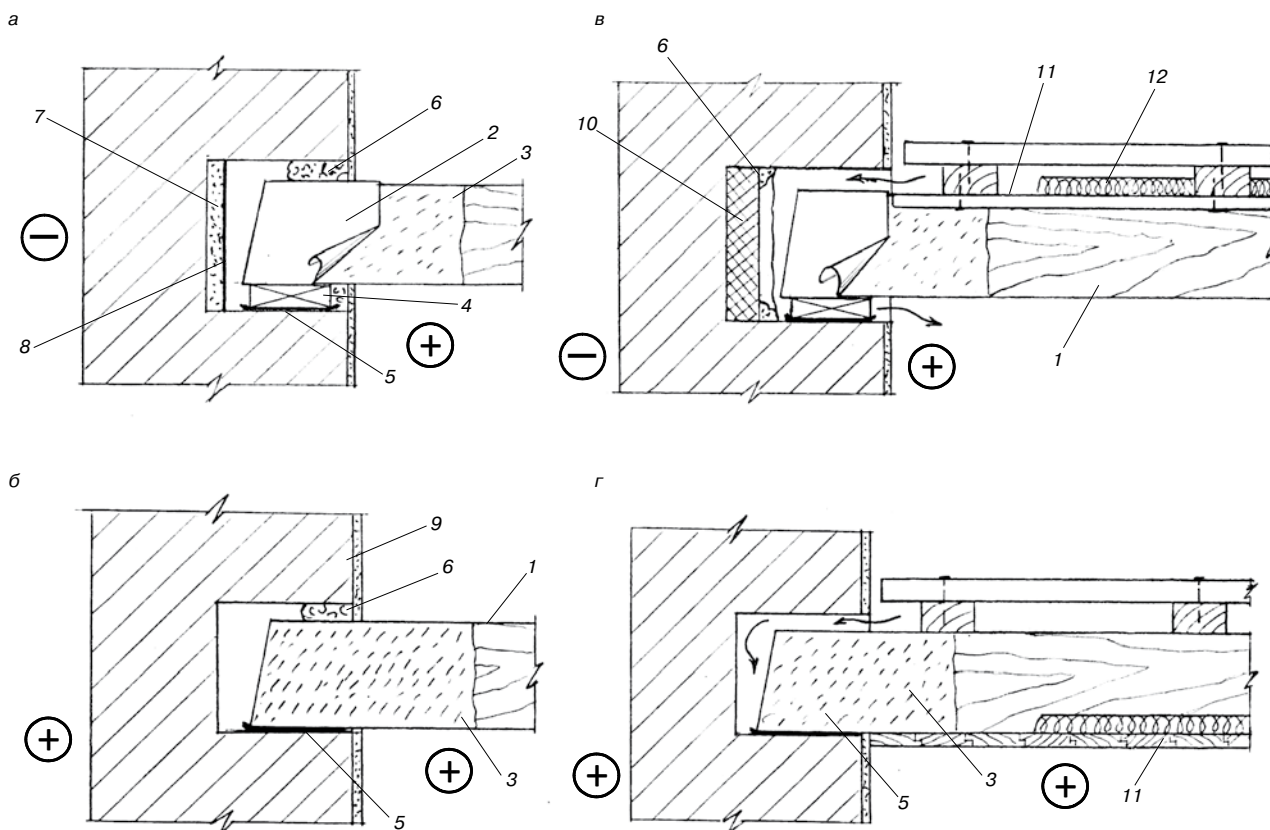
Опираие балок междуэтажного перекрытия на каменные стены: а — глухая заделка при опирании на наружную стену; б — то же, на внутреннюю стену; в — открытая заделка при опирании на наружную стену; г — то же, на внутреннюю стену; 1 — балка перекрытия; 2 — влагоизоляционный бандаж; 3 — поверхность балки, подлежащая антисептированию; 4 — деревянная антисептированная подкладка; 5 — слой гидроизоляции; 6 — монтажная пена; 7 — теплоизоляционная штукатурка; 8 — гидроизоляция; 9 — штукатурка; 10 — теплоизоляция (пенопласт, пеноплекс); 11 — доски потолка; 12 — звукоизоляция
